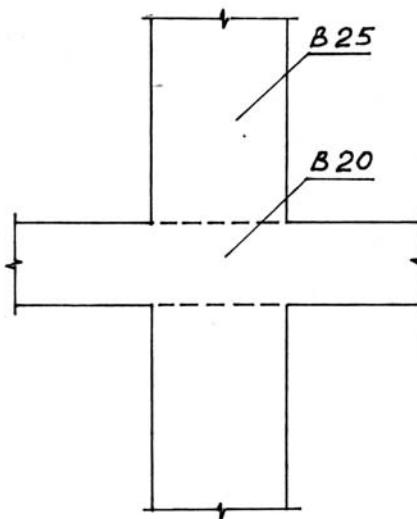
Соединение перекрытия с колонной в монолитном варианте
